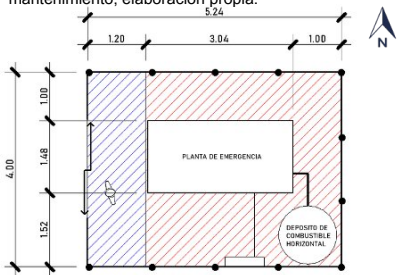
Arreglo espacial planta de emergencia, elaboración propia.
